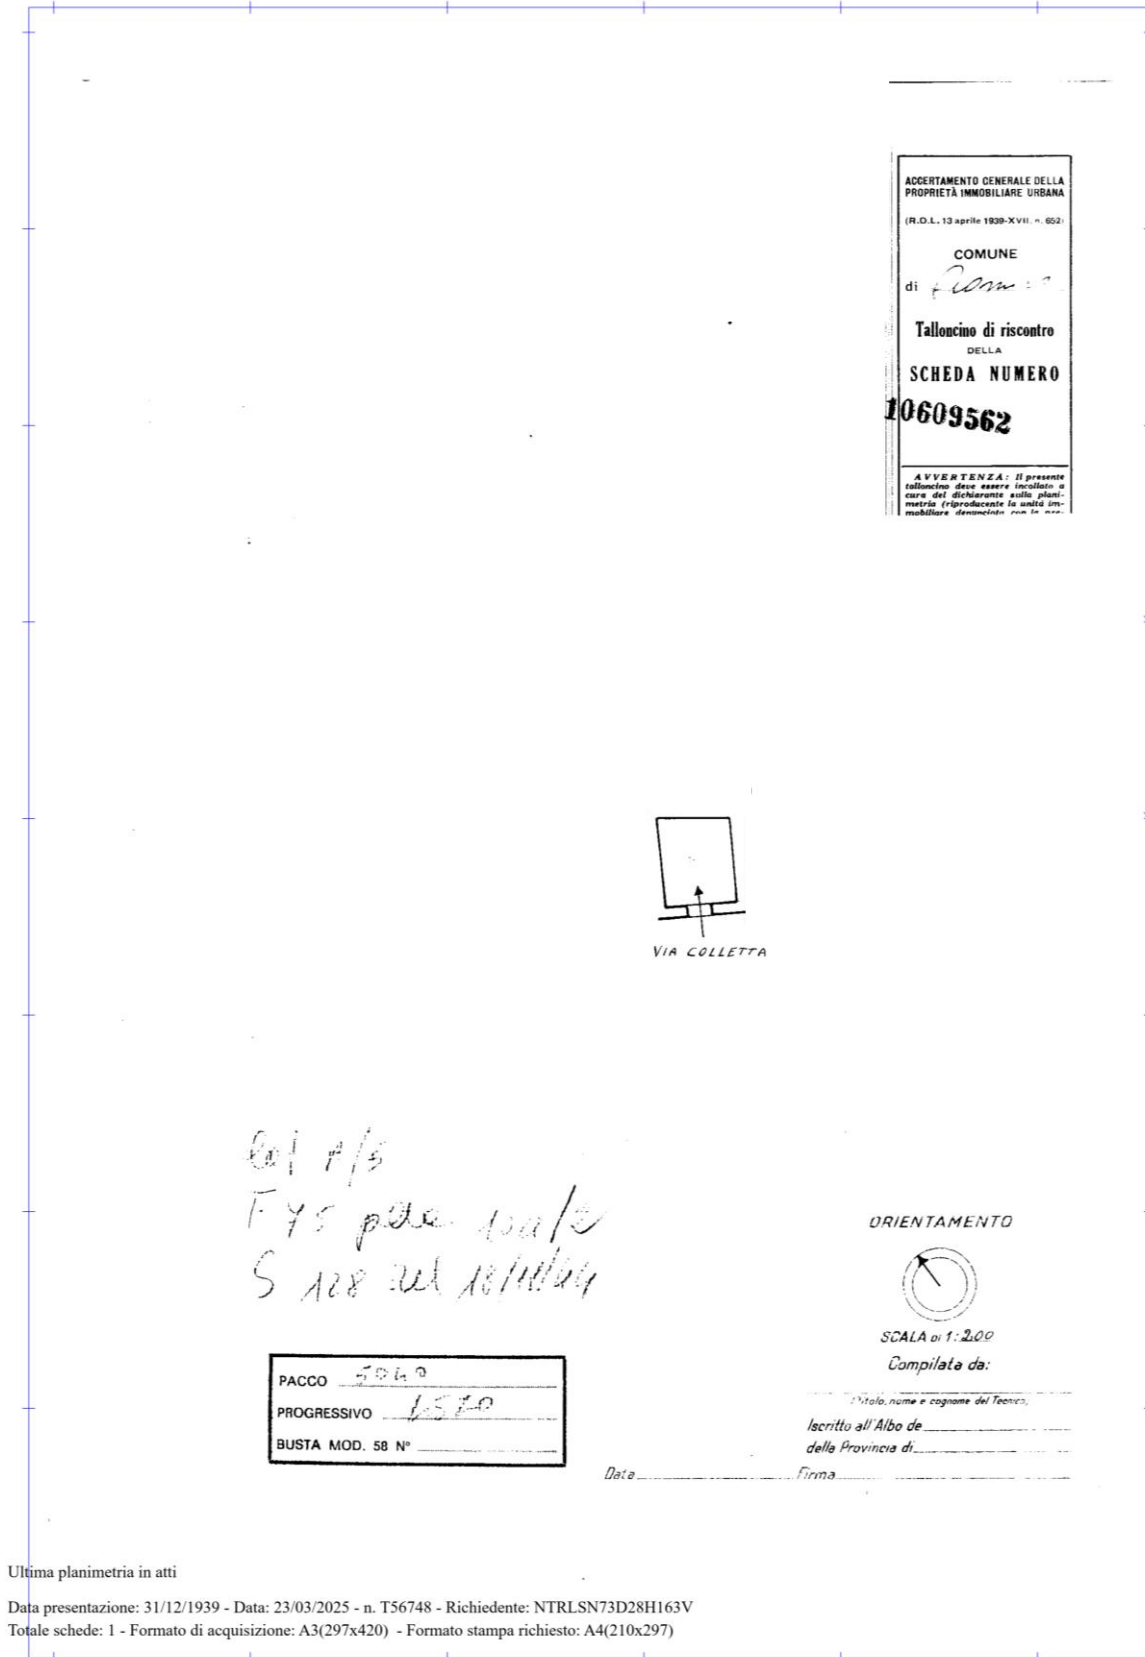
Estratto Planimetria Catastale Foglio n°75, Particella n°3748, Sub 1 - PIANO TERRA
